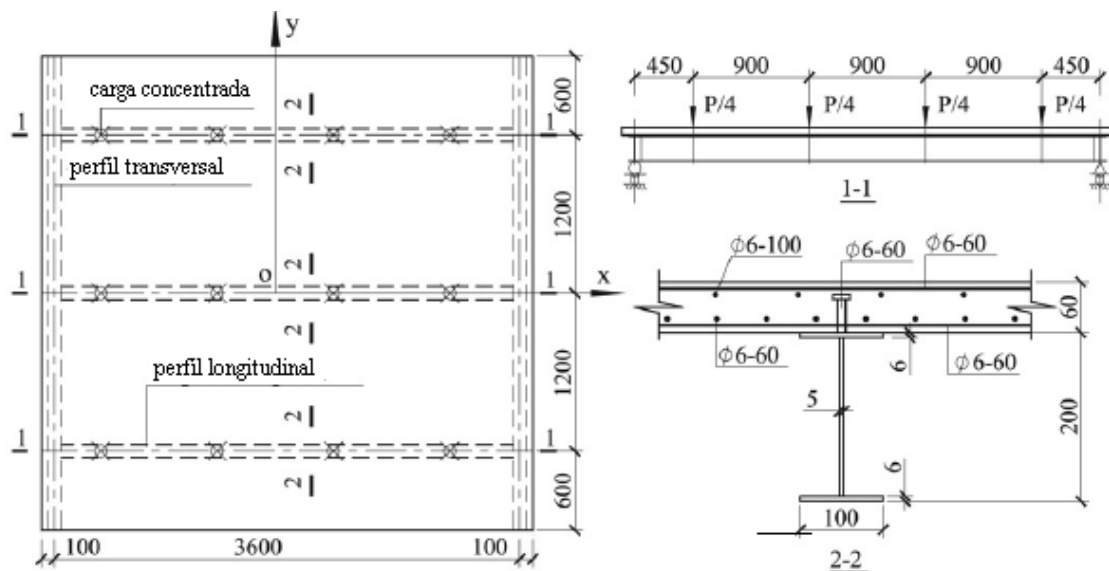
Laje Mista aço-concreto (unidades em mm) Nie *et. al.* (2008).
